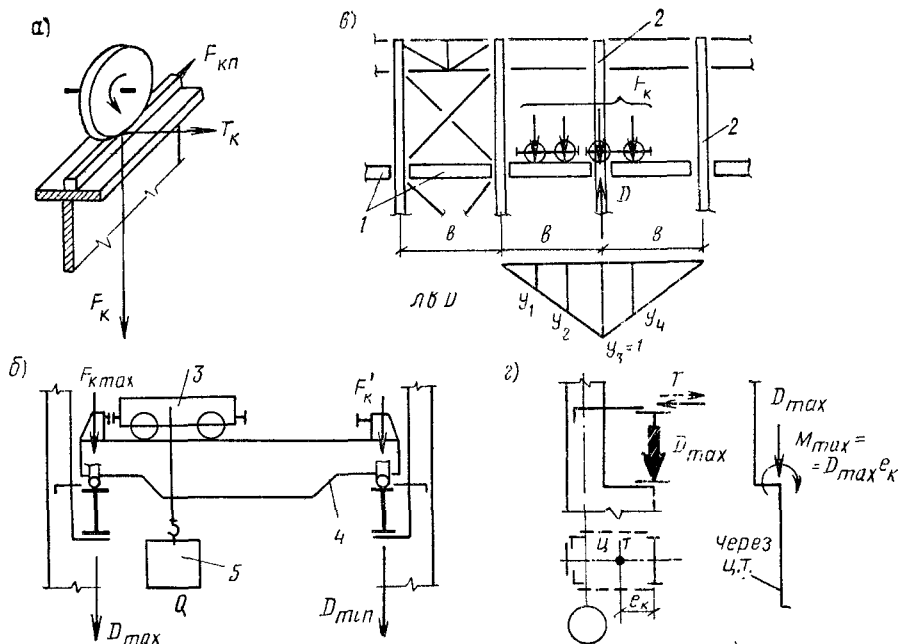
К определению нагрузок на раму от мостовых кранов
